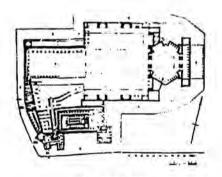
مسقط افقى و منظور لدعن الآكراد
